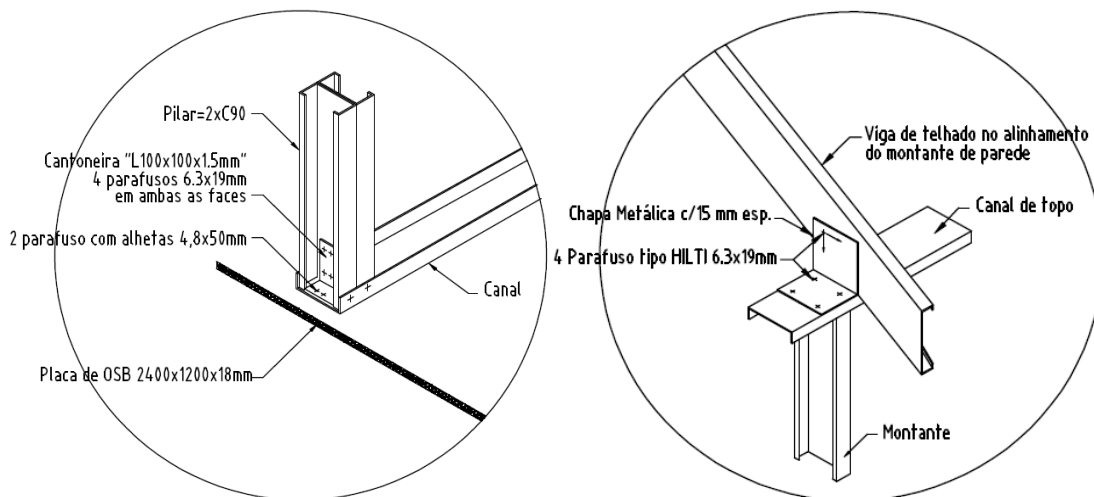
Pormenores de ligação: esquerda - ligação pilar-canal base; direita - viga de telhado com canal topo.
